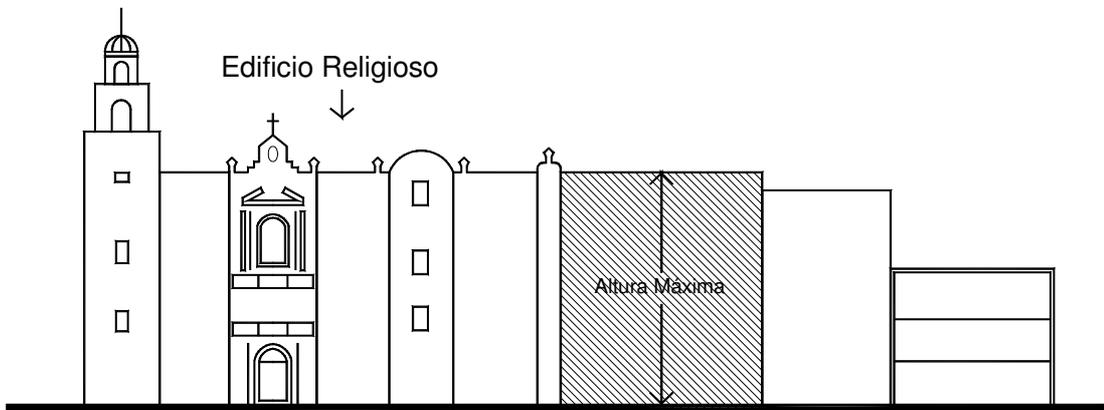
Gráfico que ilustra el Criterio A para determinar alturas en la Zona Centro
